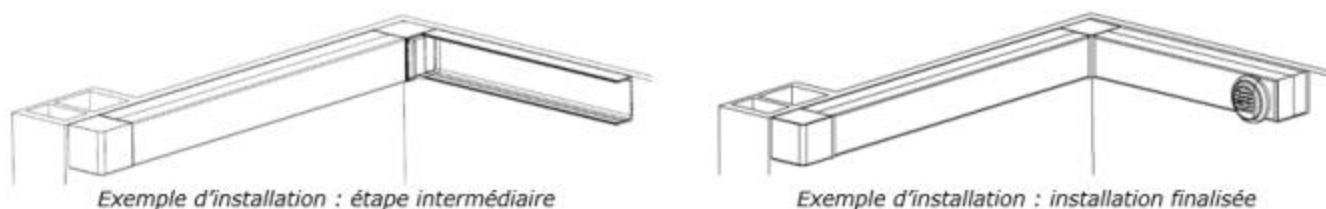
Exemples de mise en œuvre des conduits horizontaux JOK'AIR
